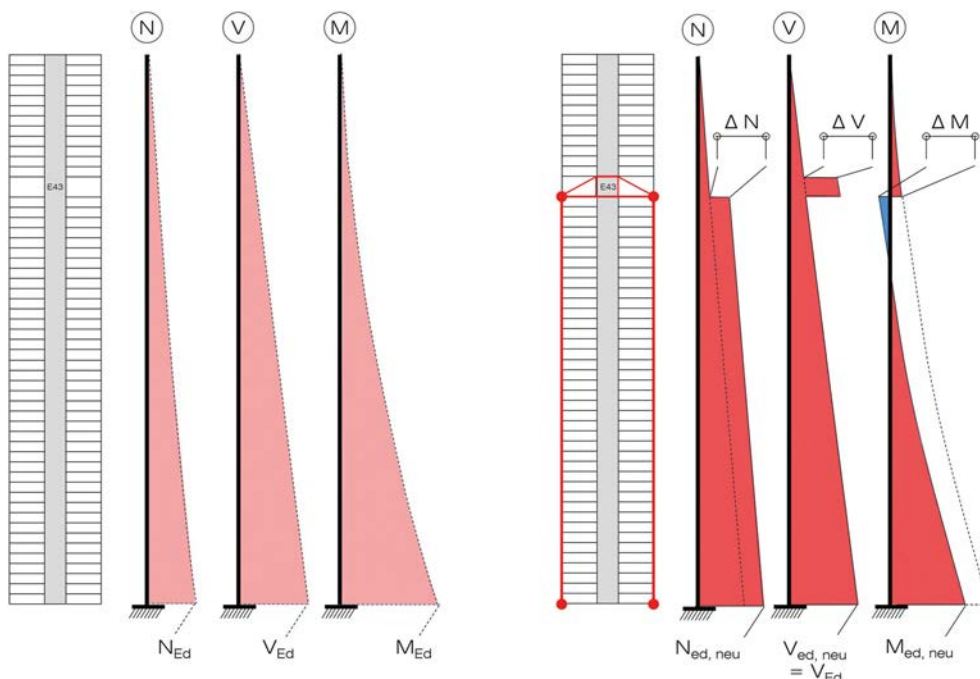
Prinzipskizze Outriggerkonstruktionen: links ohne, rechts mit Outrigger (Quelle: ATW FOUR)
